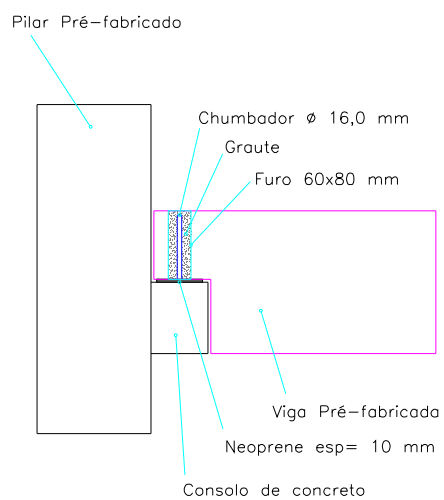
Esquema de montagem do sistema pilar-viga para a ligação com consolo.
